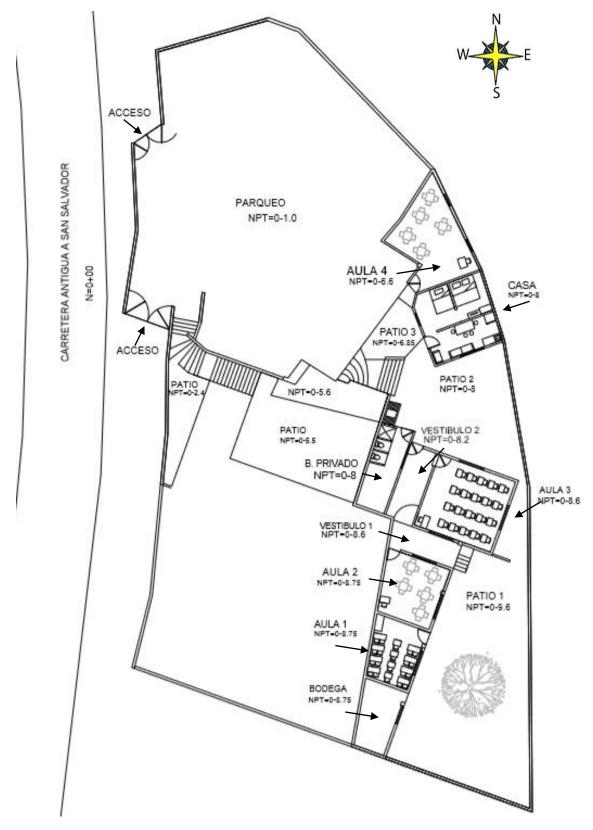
Plano de conjunto y planta arquitectónica baja primer nivel.
